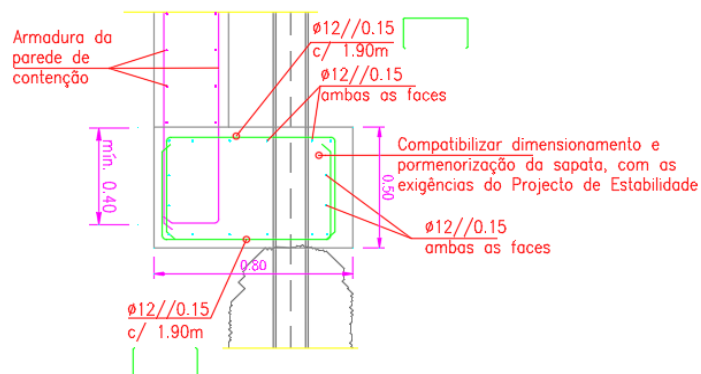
(adaptada de [10]): Pormenor da sapata instalada
